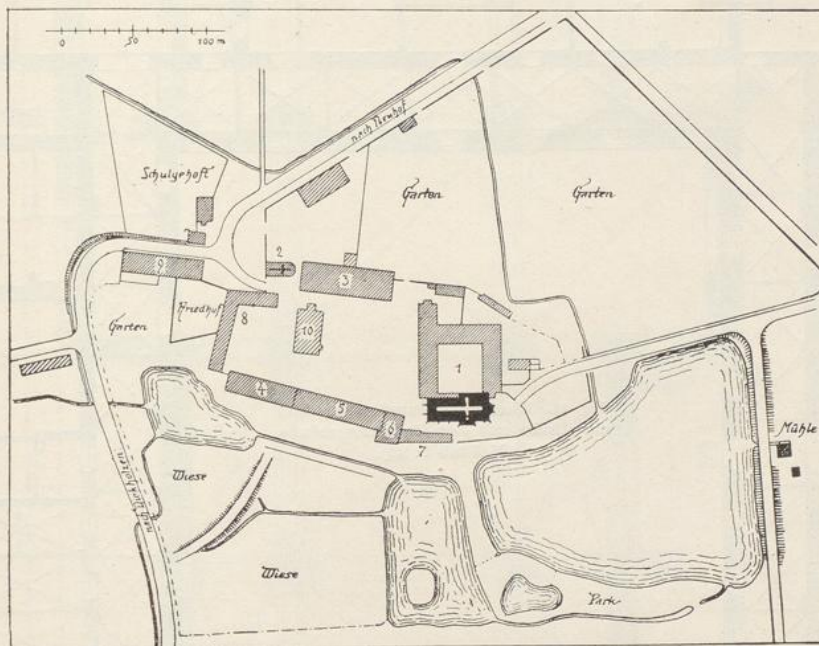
Kloster Marienrode; Lageplan (Maßstab 1:5000).
